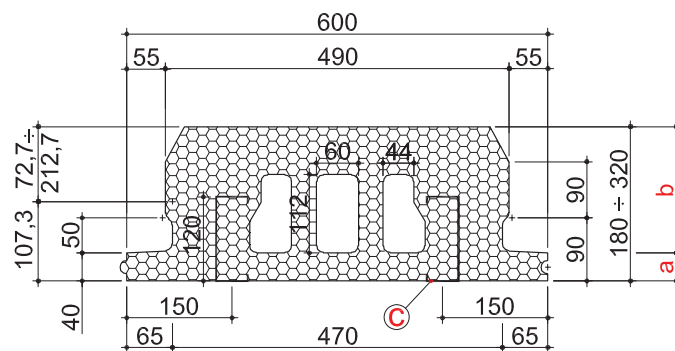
Поперечное сечение несъемной опалубки для межэтажных перекрытий и настила крыши
